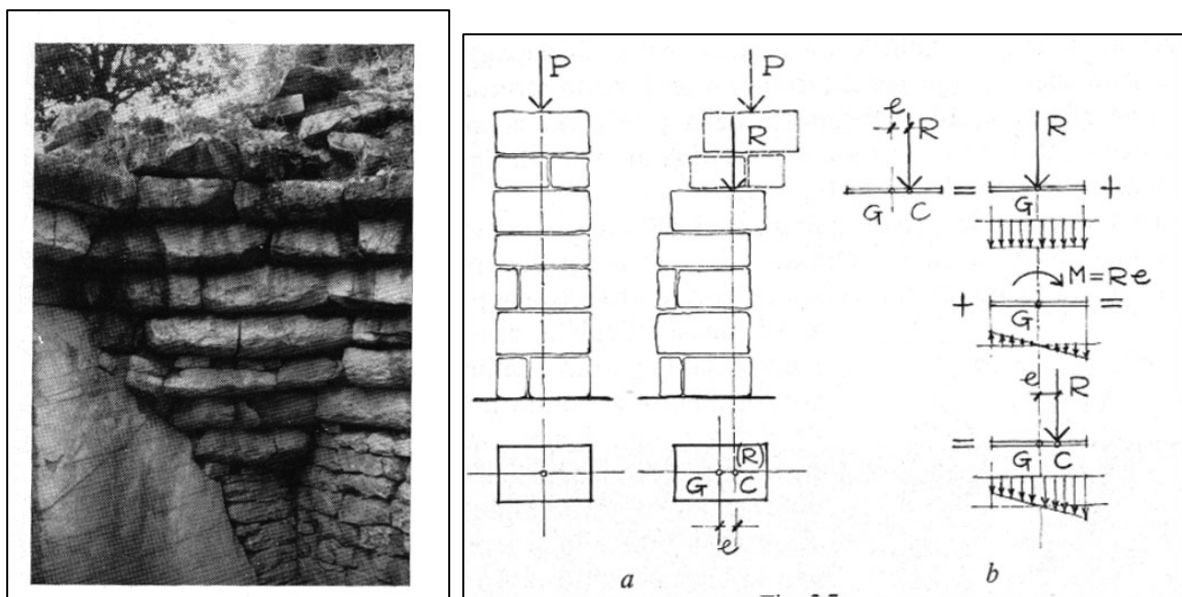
Costruzione con conci in aggetto rispetto alla verticale
